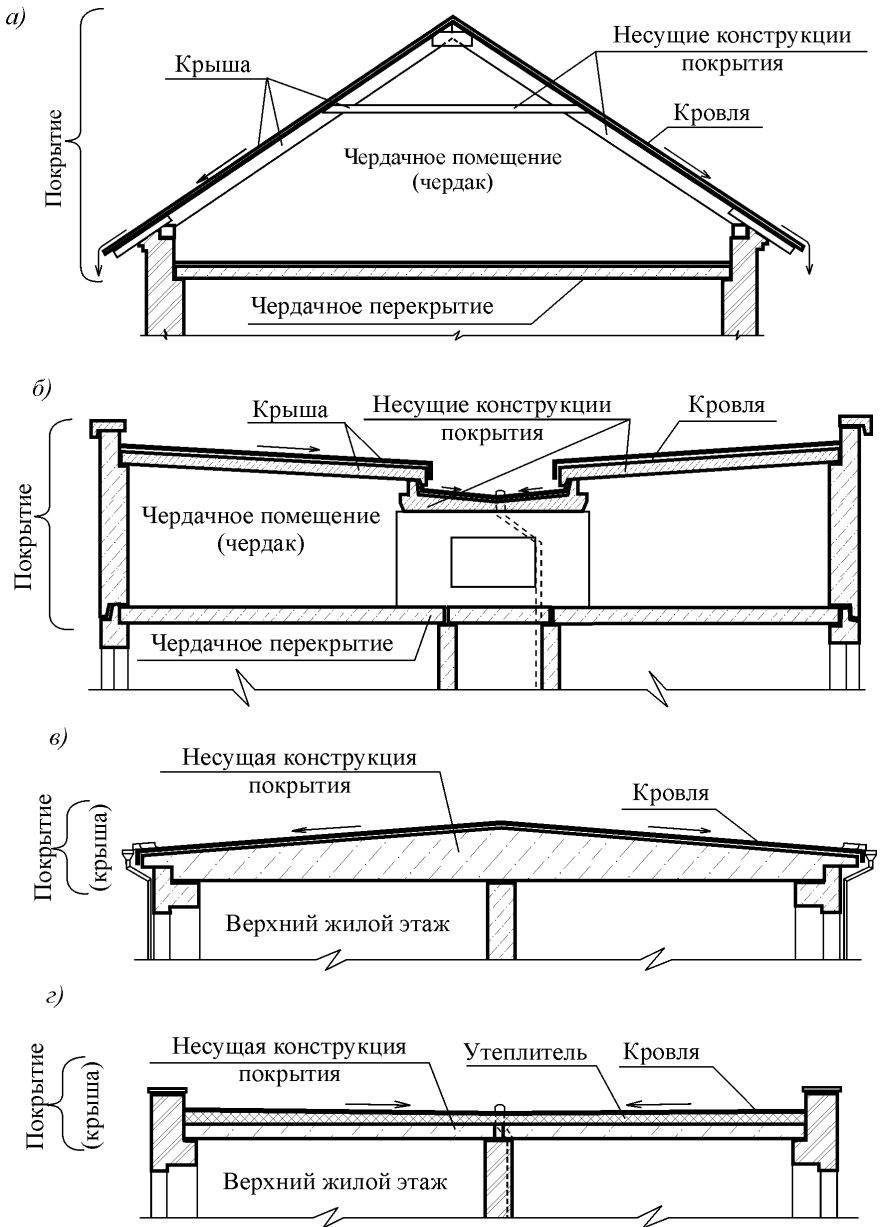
Схемы покрытий гражданских зданий (в поперечном разрезе): а - чердачных покрытий мало- и среднеэтажных зданий; б - чердачных покрытий многоэтажных зданий; в, г - бесчердачных покрытий мало- и среднеэтажных зданий
